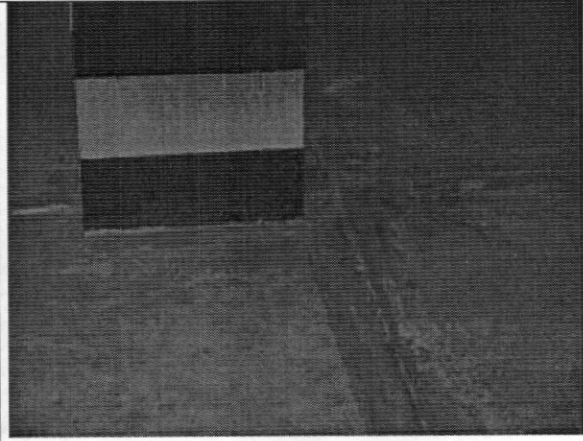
Asentamiento placa de contrapiso, eje de columnas cercano a la plataforma.
